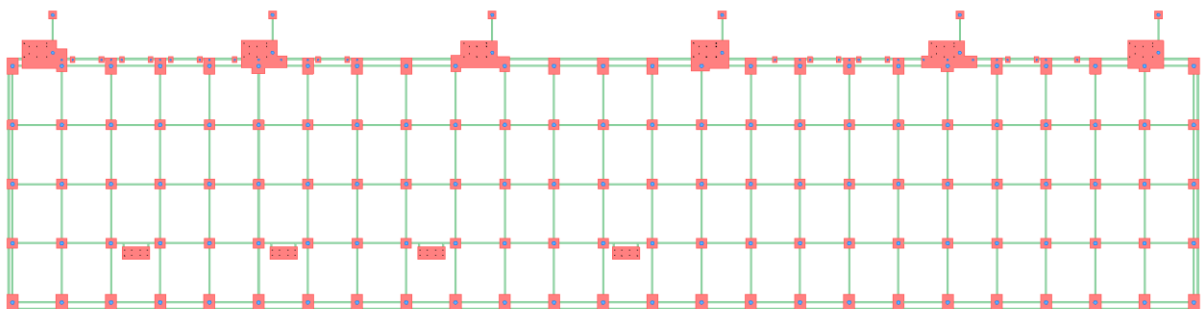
Plano de planta de la estructura. En rojo, losas y zapatas; en verde, vigas de atado; y en azul, pilares.
